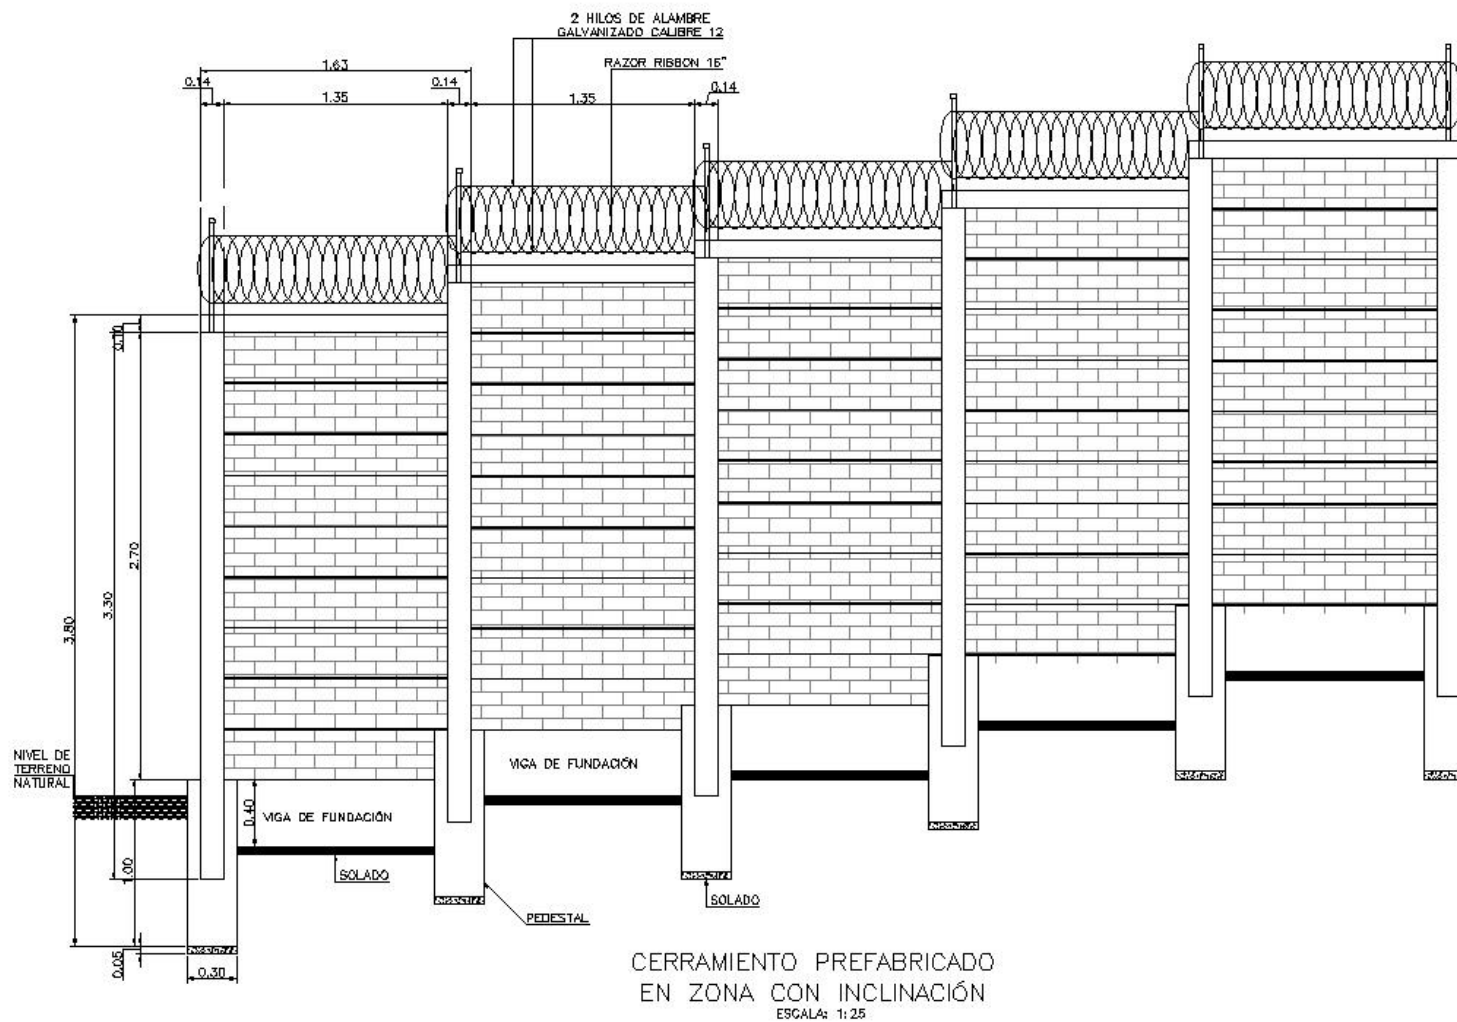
Elevación de cerramiento prefabricado en zona con inclinación
